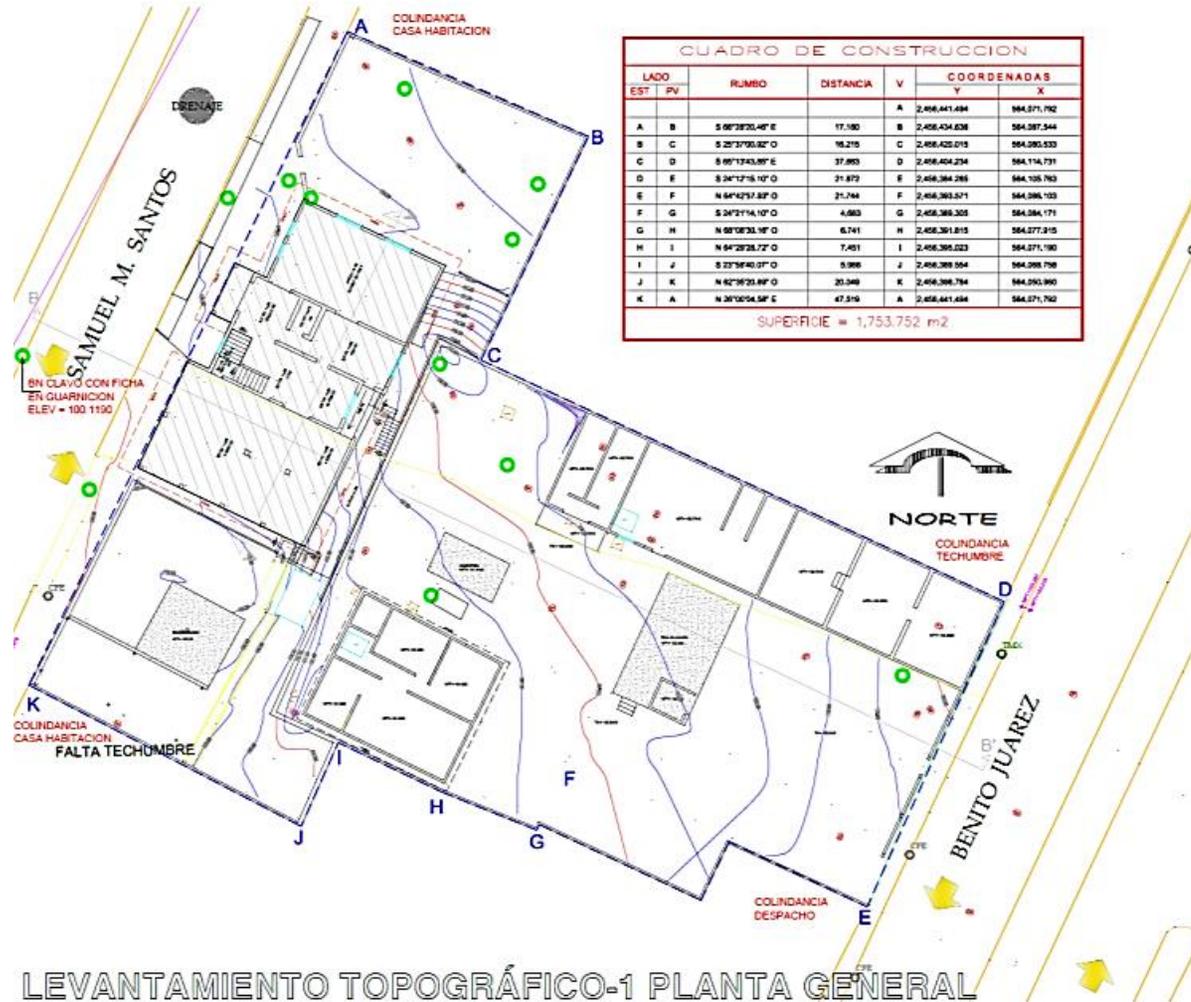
Construcciones existentes dentro del predio donde se construyó Coppel Juárez, Ébano, SLP
